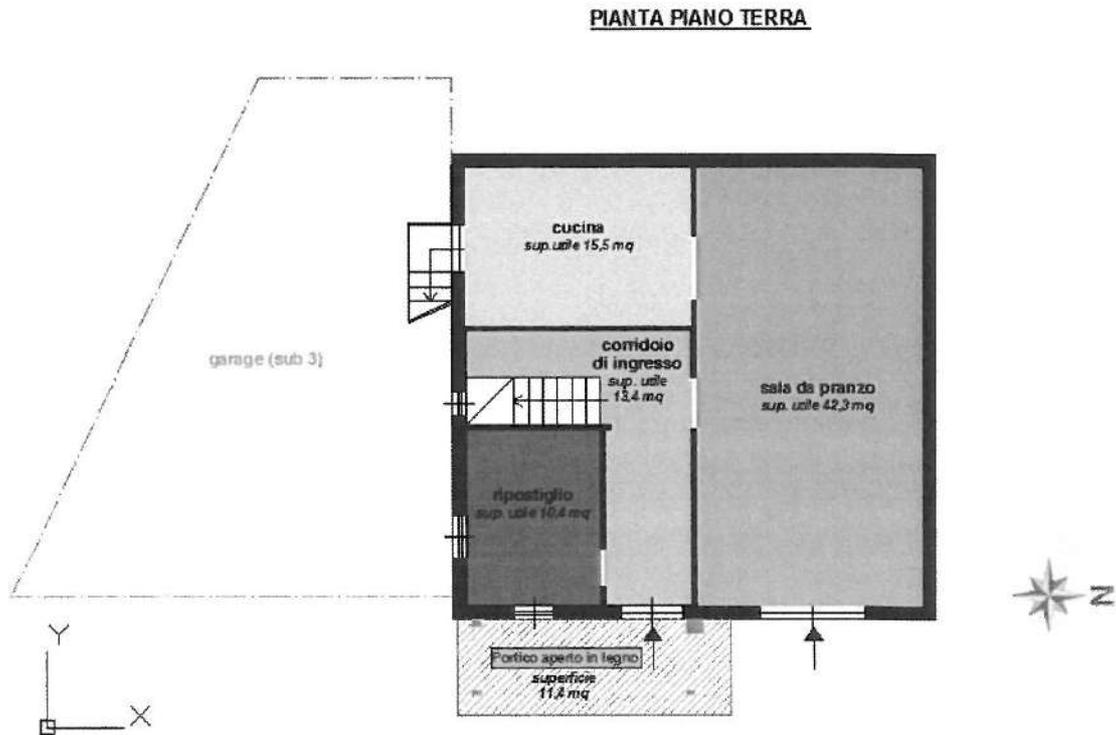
PIANTA PIANO TERRA-STATO ATTUALE
